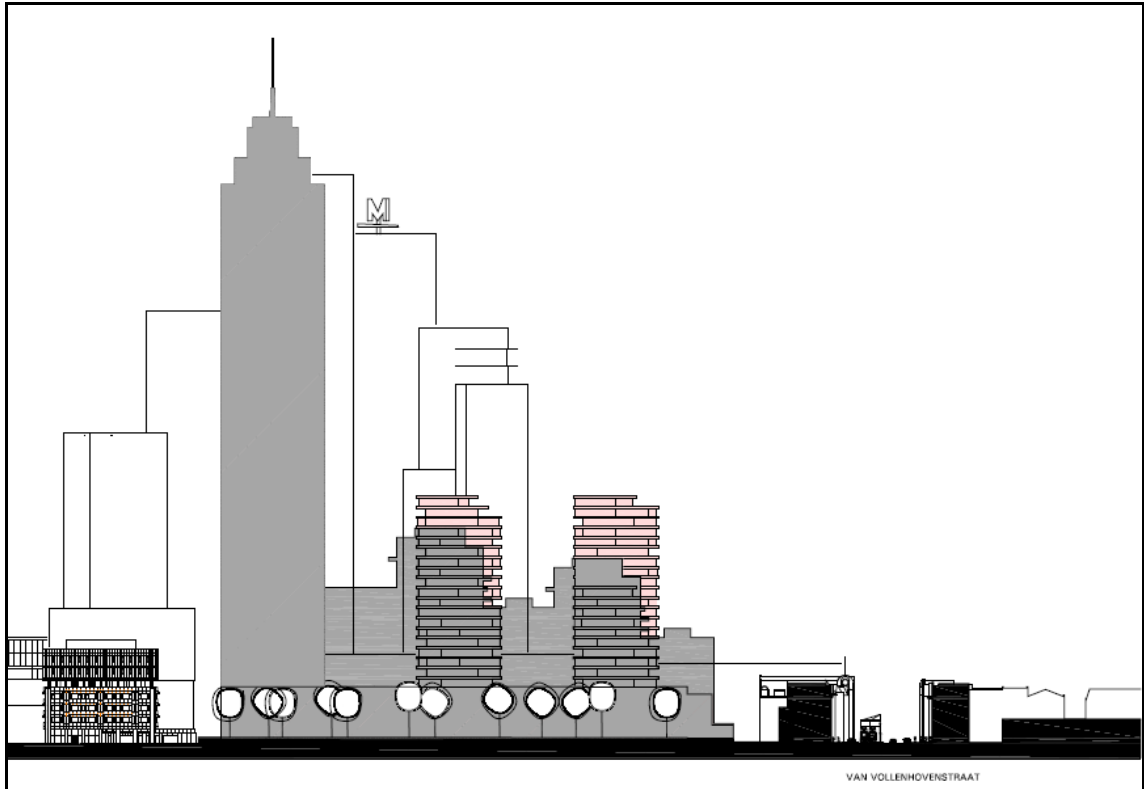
Links het te slopen kantoorgebouw, rechts het woongebouw 'Gedempte Zalmhaven'.
